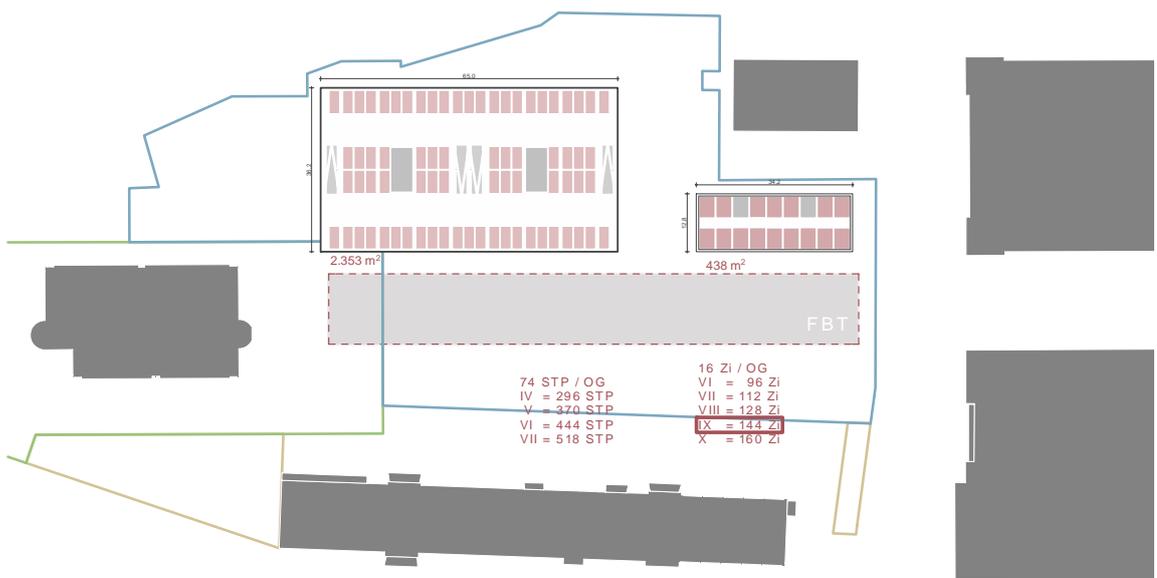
Standort AB - Variante C – Systemgrundriss Regelgeschoss
